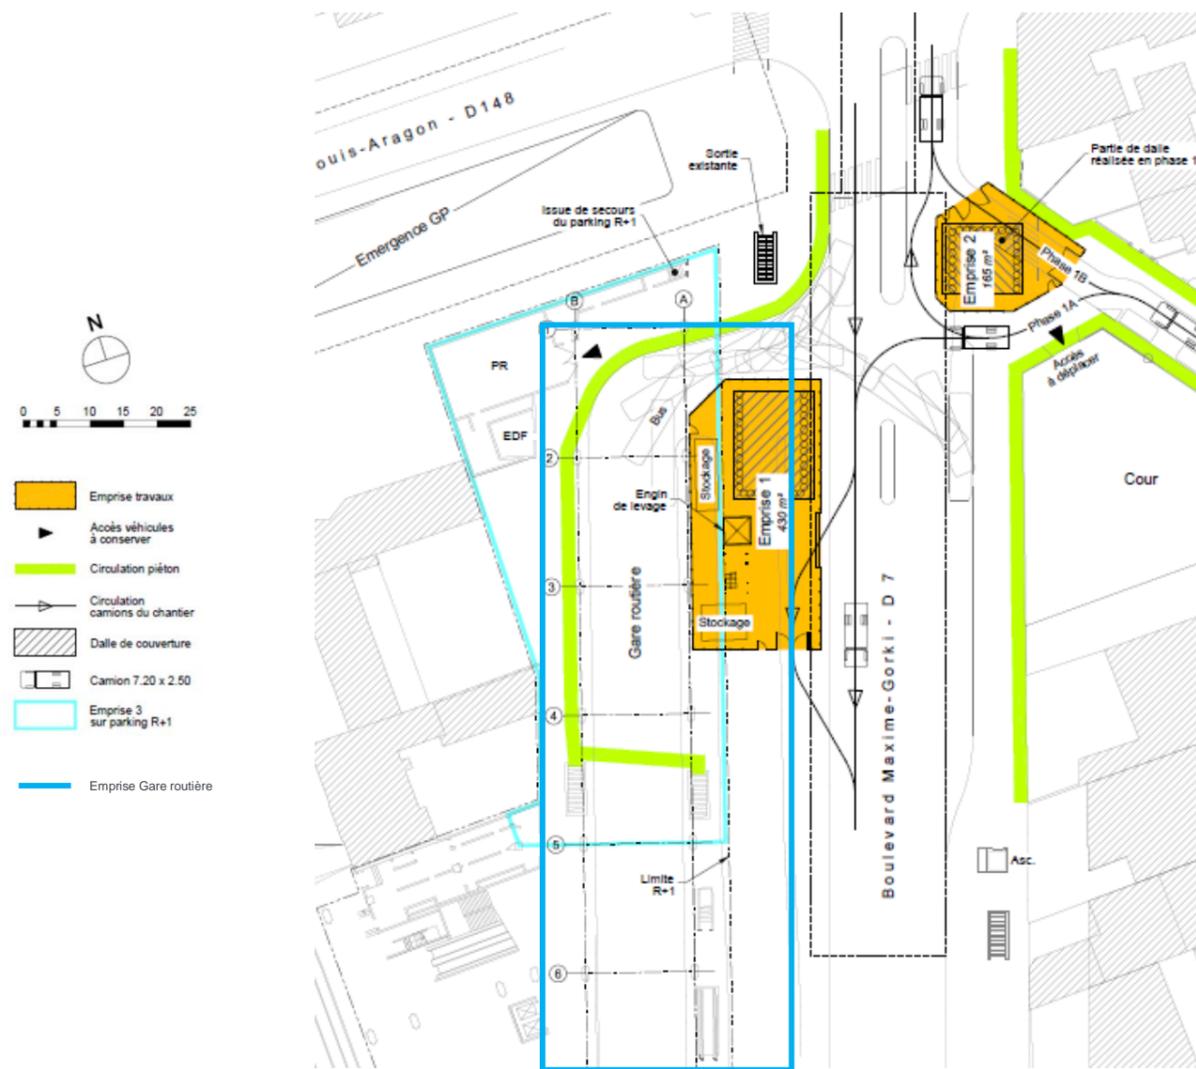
VLA – Exemple de l’impact des emprises travaux en gare routière
